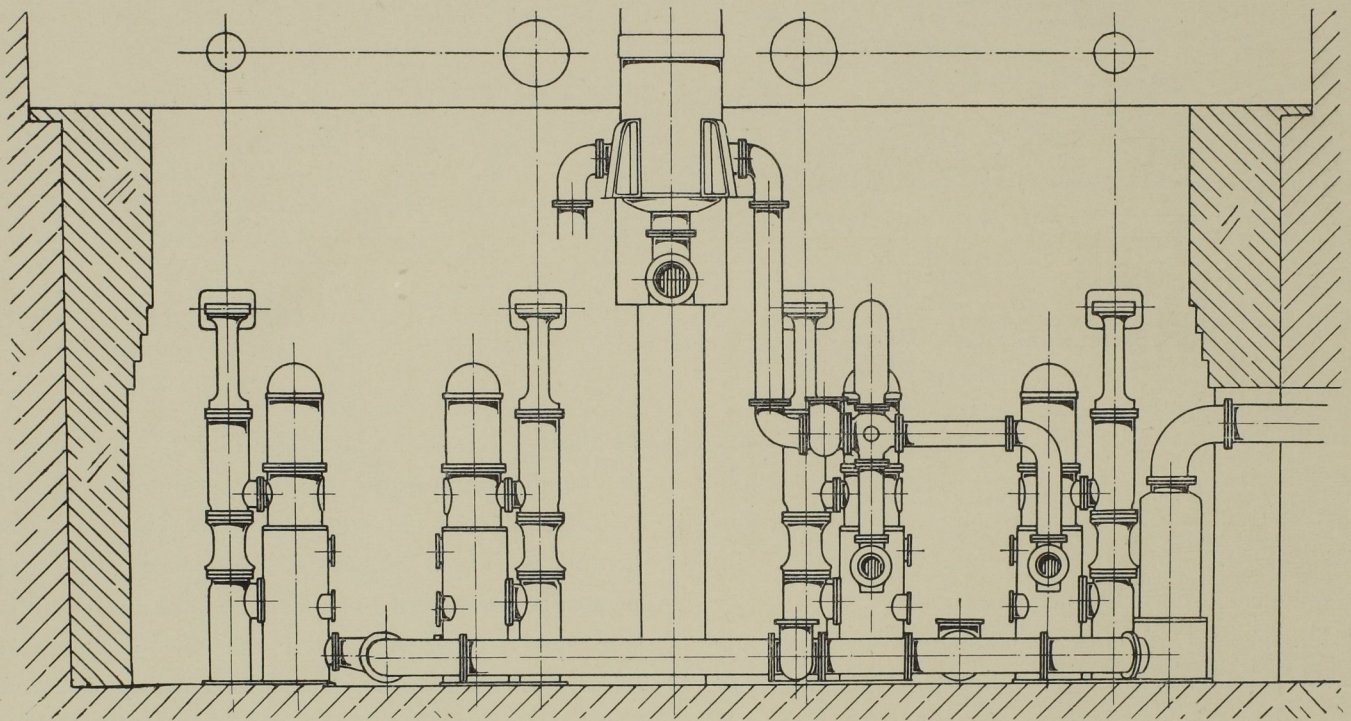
Stirnansicht der Druckpumpen. Massst. 1:80.
